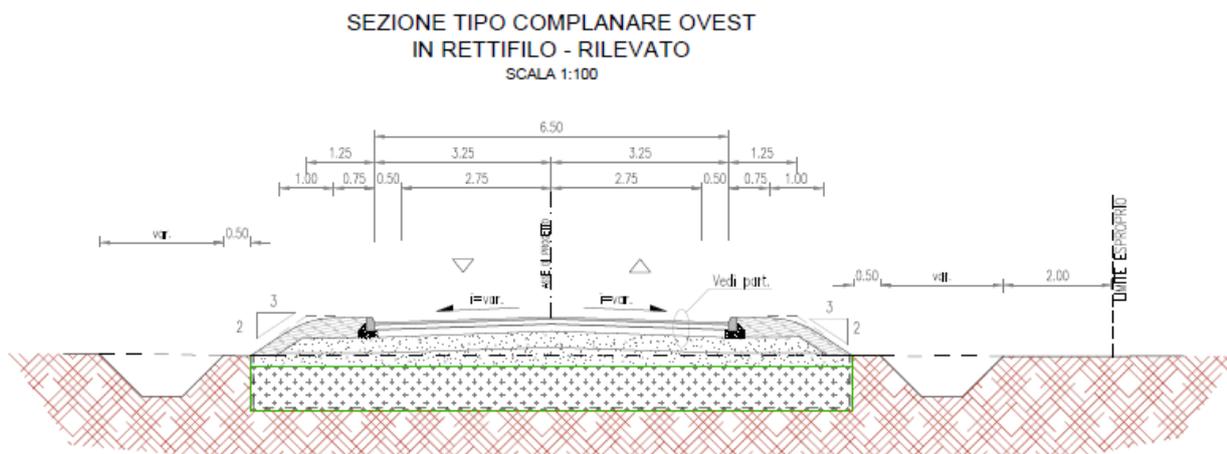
Sezione Tipo Complanare Ovest in rettifilo
